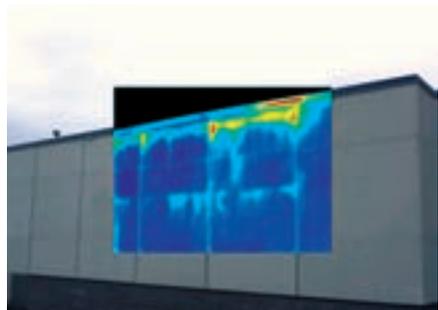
La humedad provocada por el drenaje inapropiado de un tejado puede penetrar en los bloques de cemento y la fachada de un edificio.
